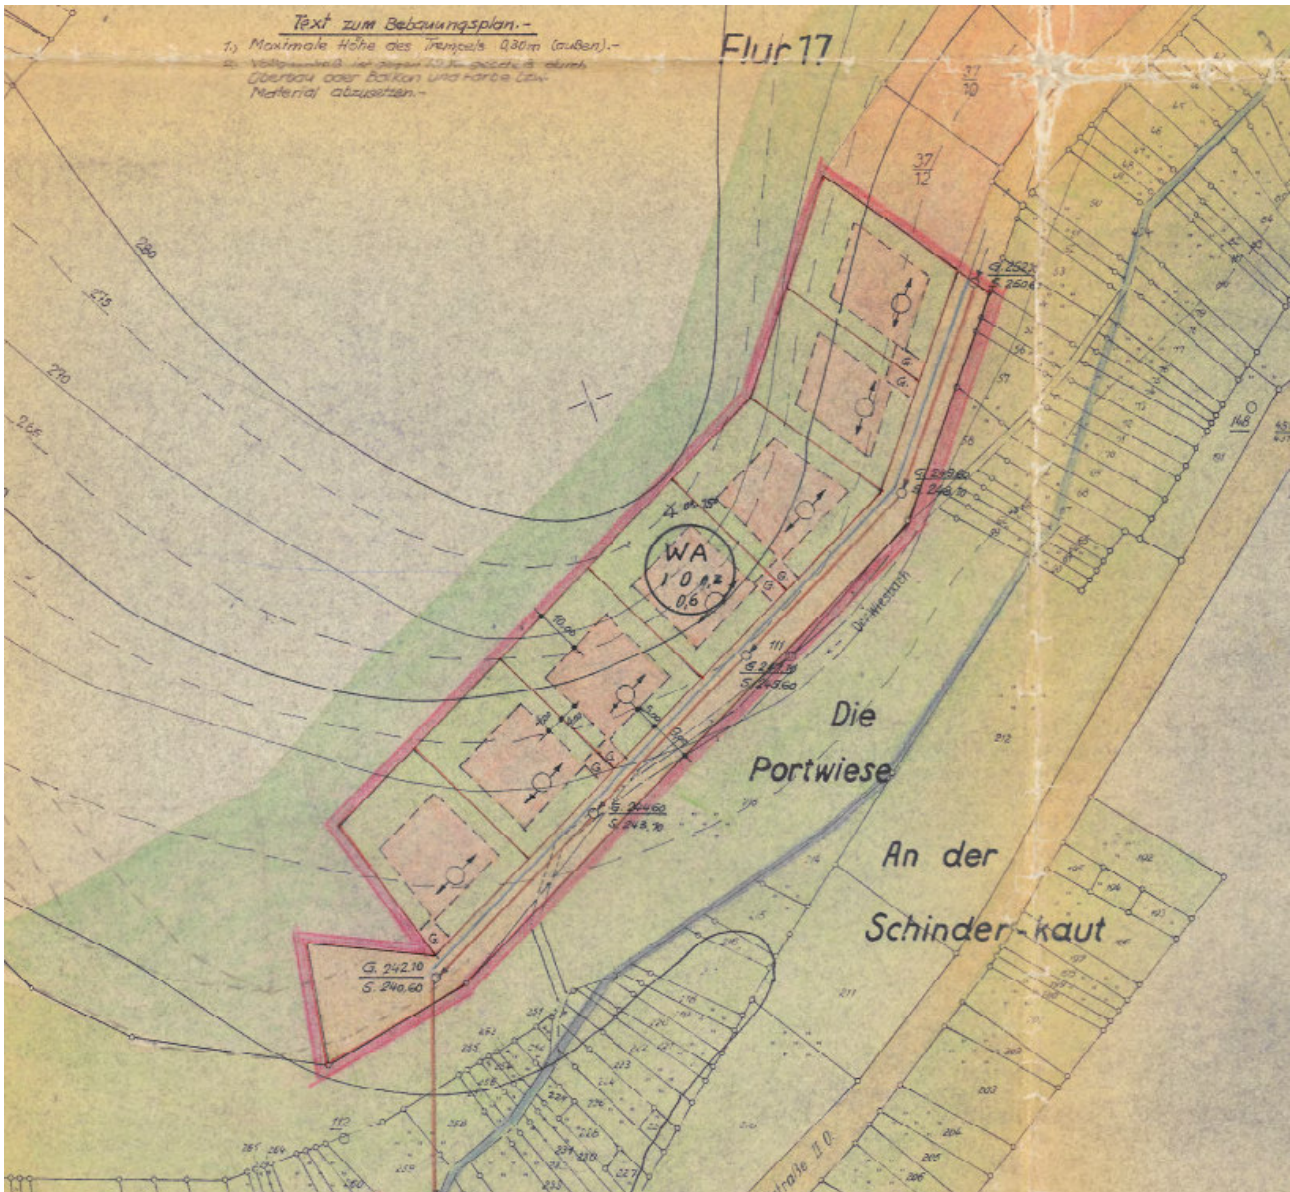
ursprünglicher Bebauungsplan, nur Planzeichnung, nicht genordet
